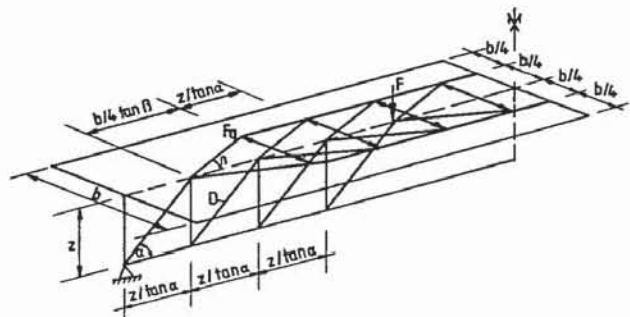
Fachwerkmodell für den Anschluß einer Druckplatte an den Steg (nach [34])
